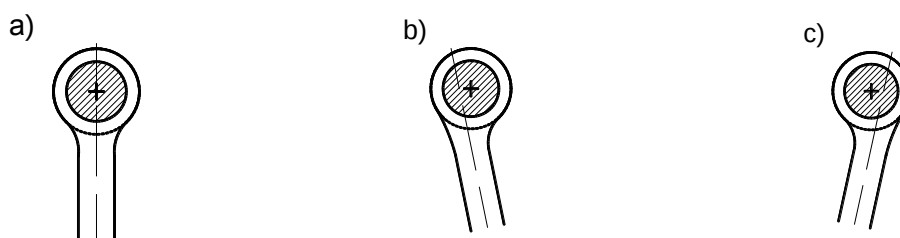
Soluții de sistematizare ale brațelor intersecțiilor cu sens giratoriu
